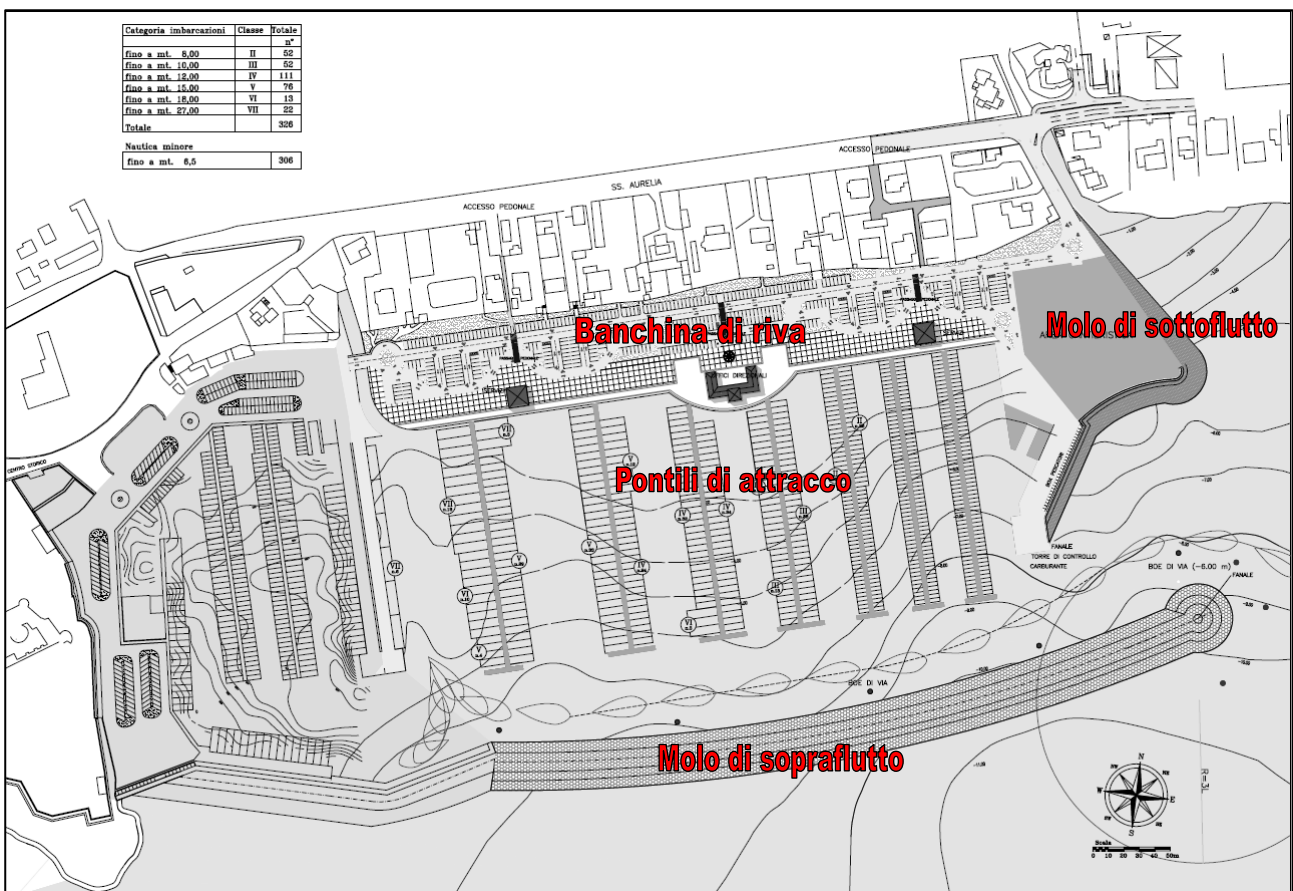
Planimetria di progetto con indicazione delle opere da realizzare
